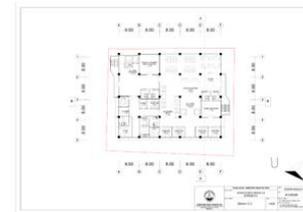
7. Denah Lantai Ground (Sumber : Dokumentasi Pribadi)
